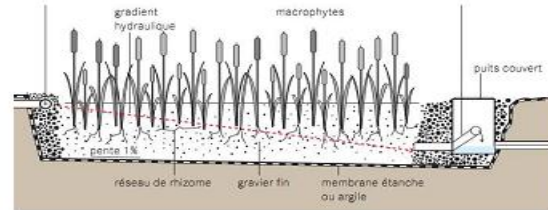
filtre plante à écoulement horizontal sous-surface [Elizabeth T. et al, 2008]
